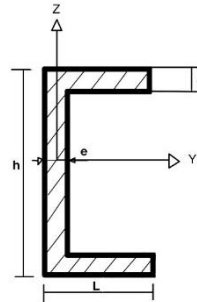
Sección barras 2 y 22, con ejes de coordenadas
